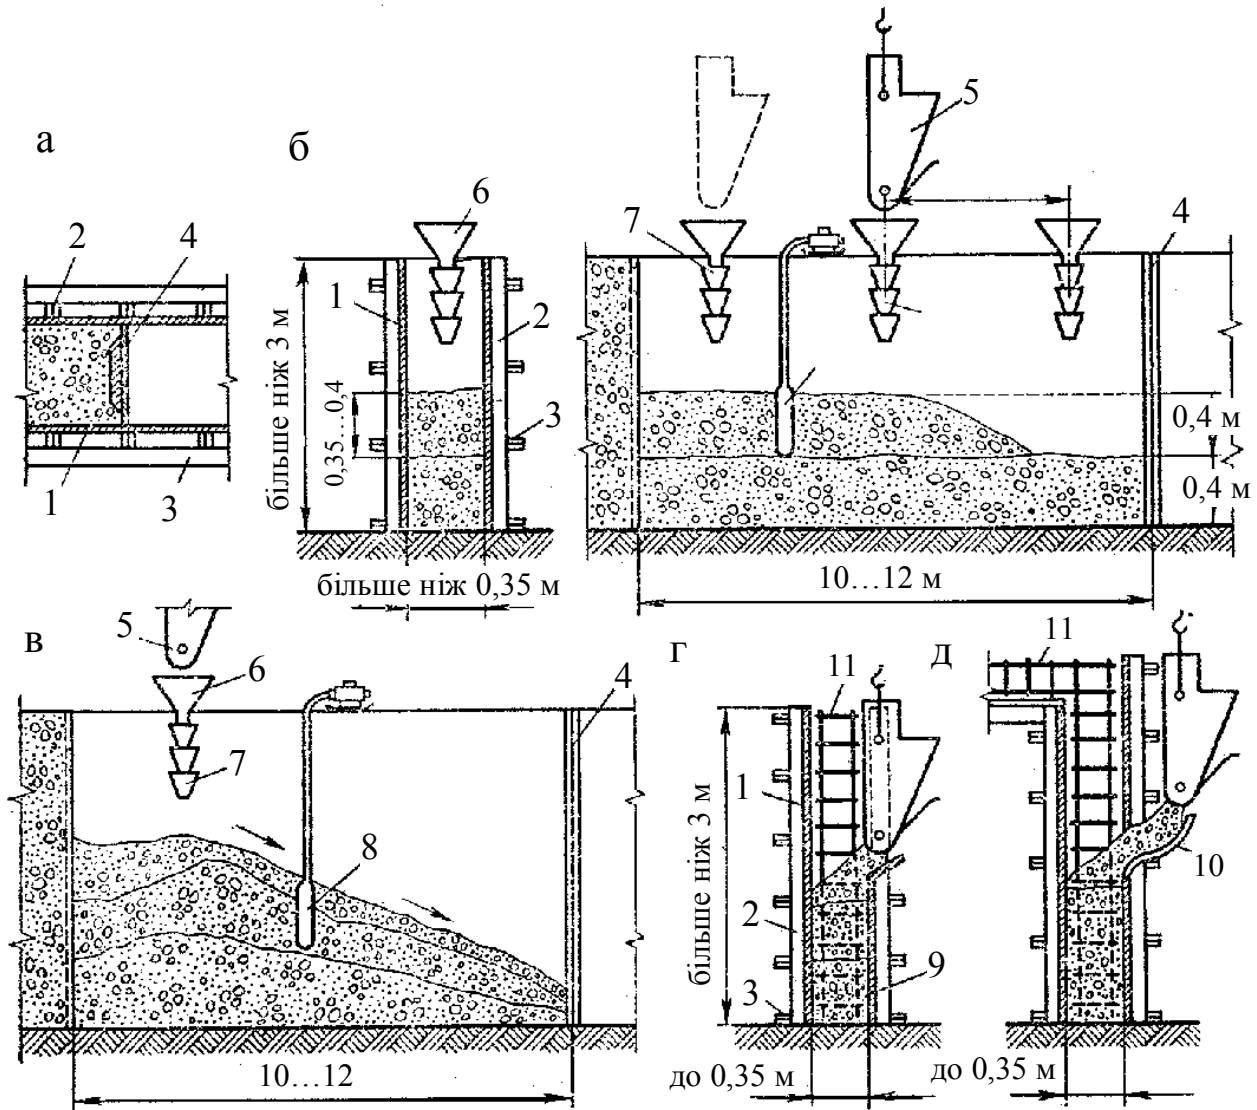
Бетонування стін: а – установлення розподільної опалубки; б – пошарове бетонування стін; в – неправильне бетонування стін з подаванням суміші в одне місце; г, д – бетонування високих густо армованих стін; 1 – опалубка; 2 – підсилювальні ребра опалубки; 3 – захват; 4 – організація робочого шва; 5 – баддя; 6 – приймальна воронка; 7 – ланковий хобот; 8 – вібратор; 9 – шари бетону; 10 – кишень; 11 – арматура
